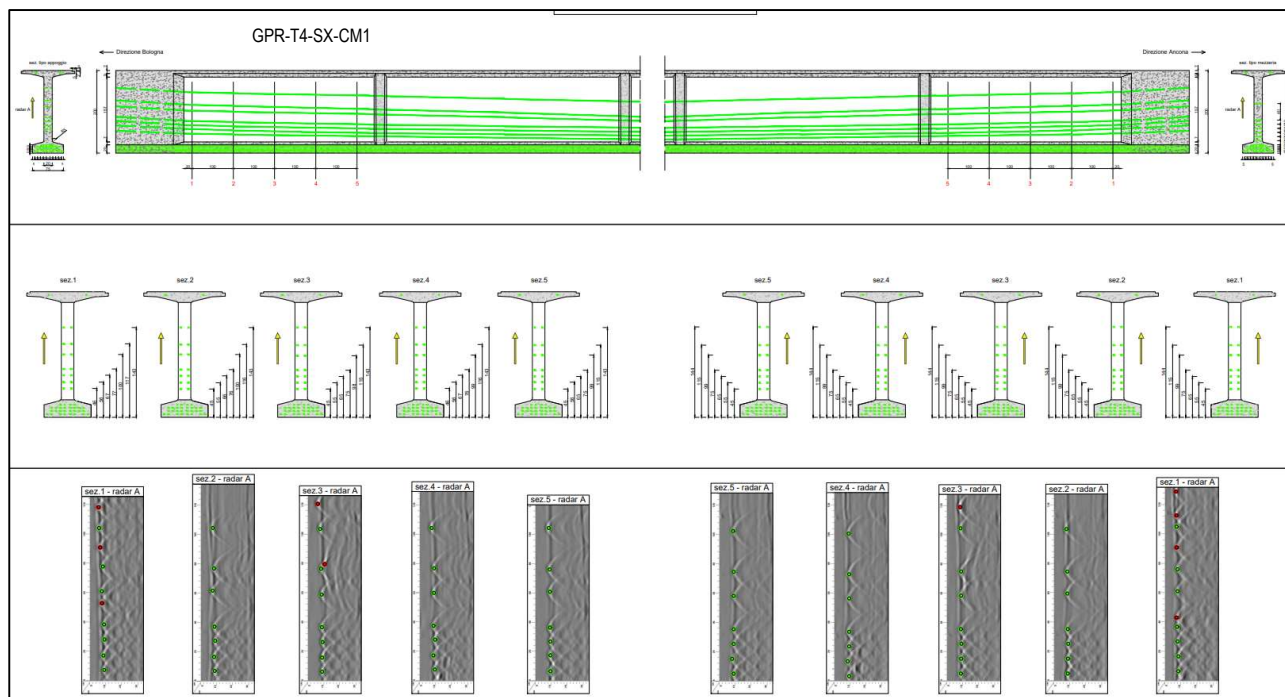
Identificazione del sistema di precompressione – Esempio ubicazione sezioni e zone di rilievo con posizionamento armatura di precompressione (es. travi pre-tesi)
